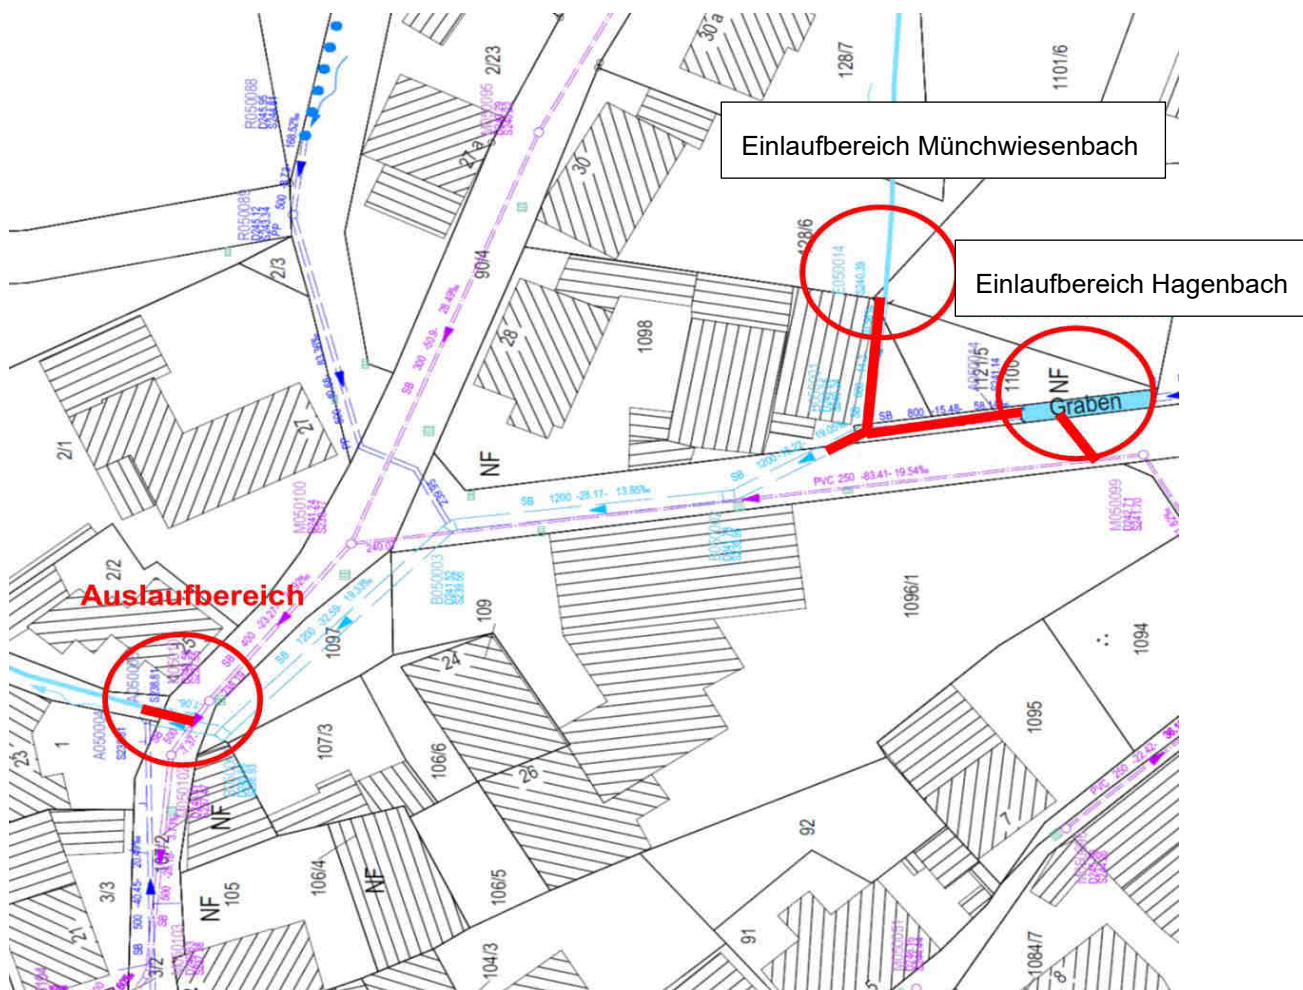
Lageplanausschnitt Hagenbachverrohrung
